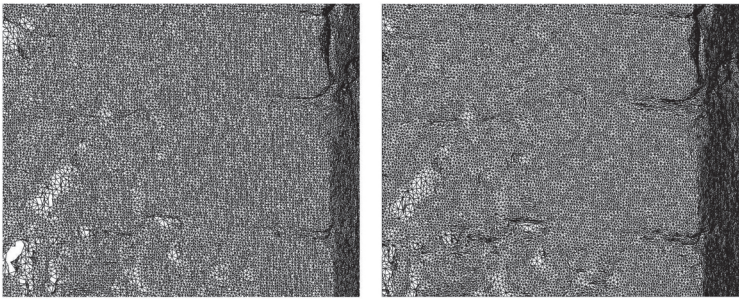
Detalle del mallado practicado en el muro de la fachada sur, antes y después del rellenado de agujeros.
